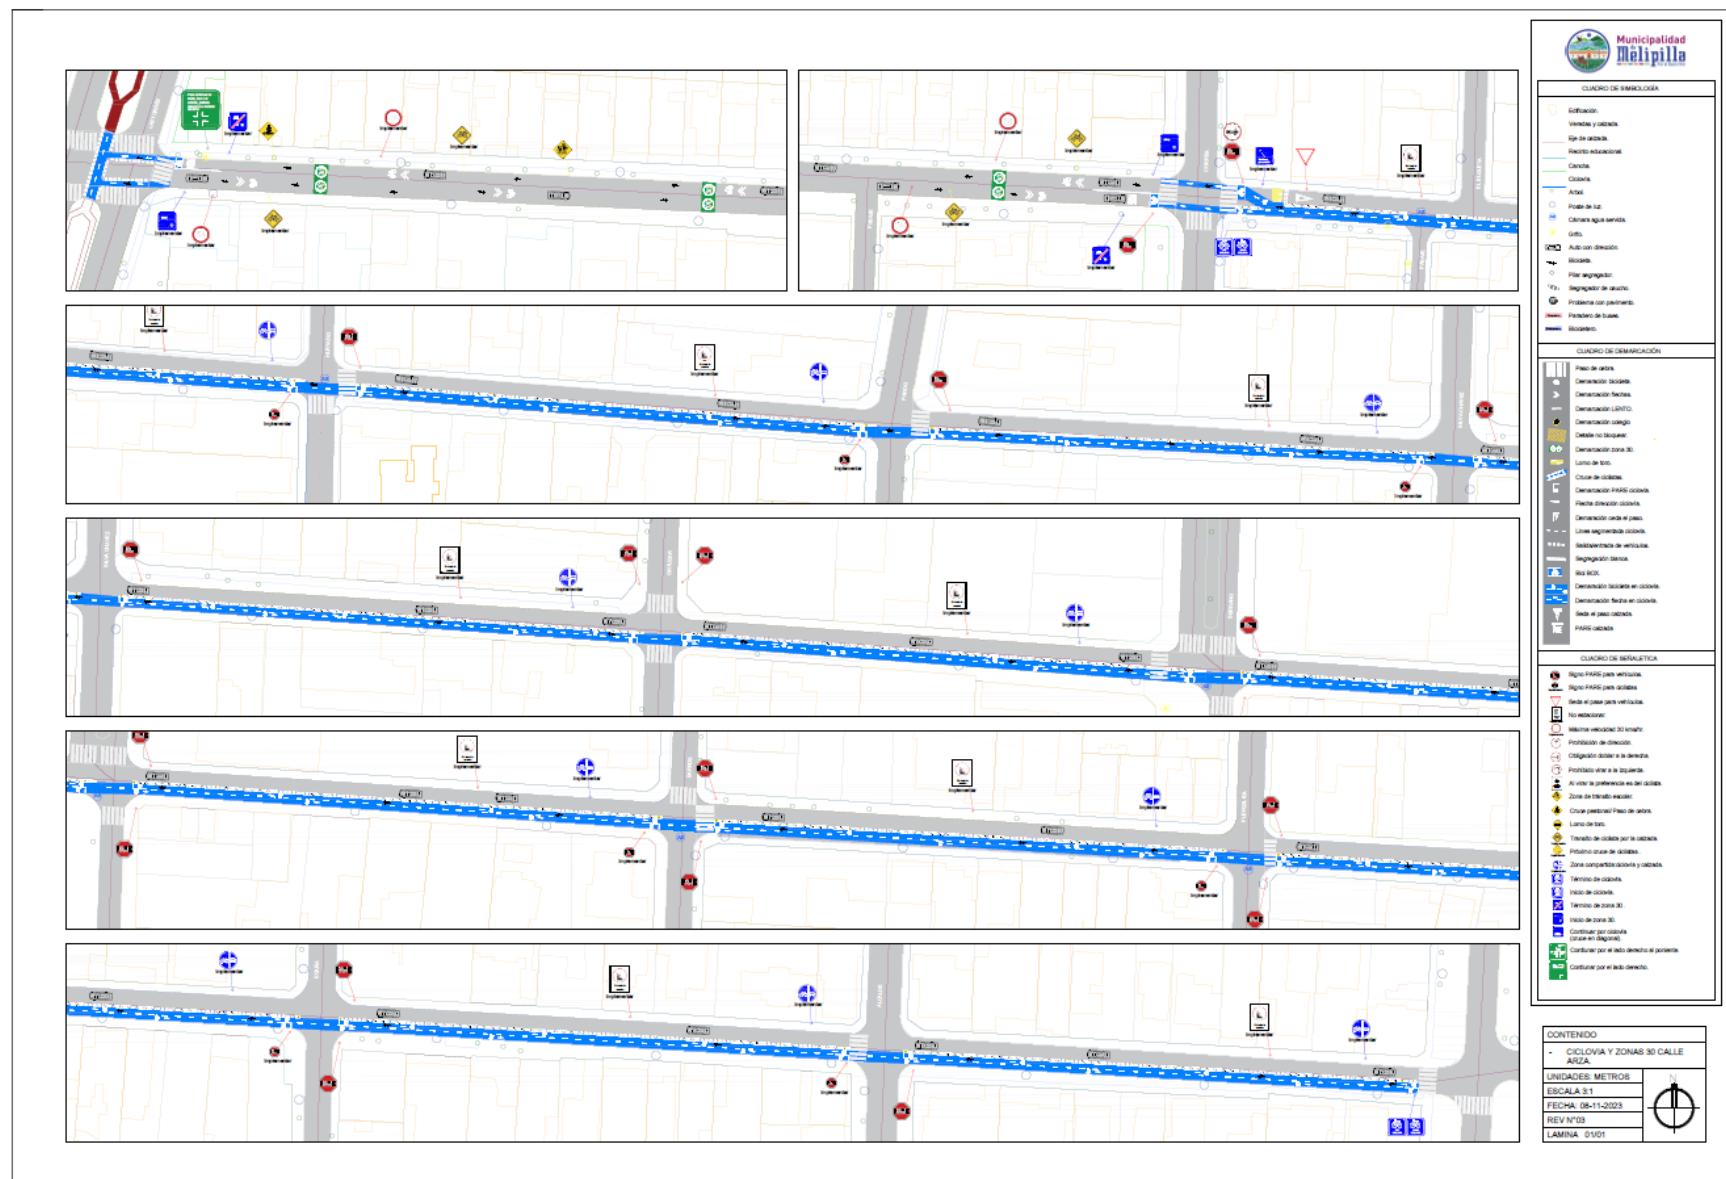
Plano ciclo-infraestructura vía calle Arza. Elaboración propia.
